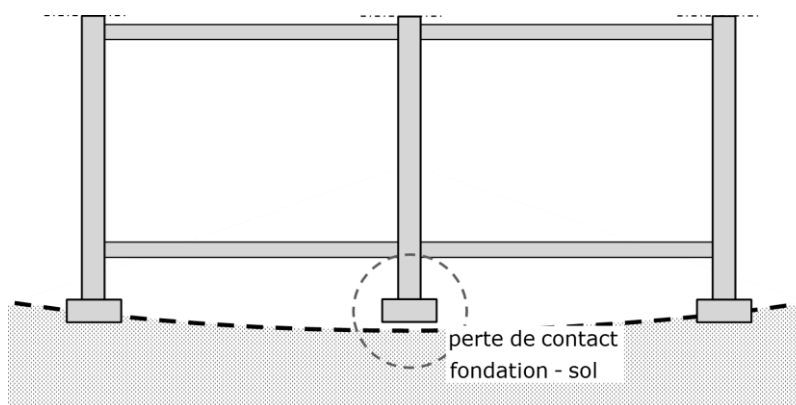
exemple d'une perte d'appui des fondations engendrée par une courbure concave du terrain
